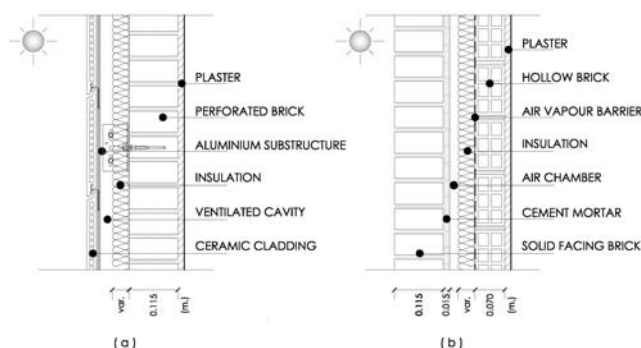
Fachada ventilada frente a fachada caravista de doble hoja cerámica con aislamiento interior [17, 18]
